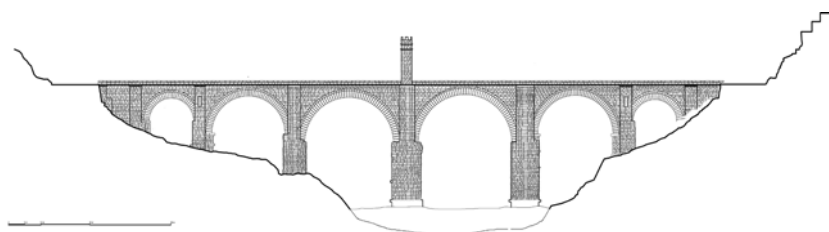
Ponte di Alcántara, modello architettonico 2D. Prospetto nord-est (elaborazione di Carlo Inglese).
